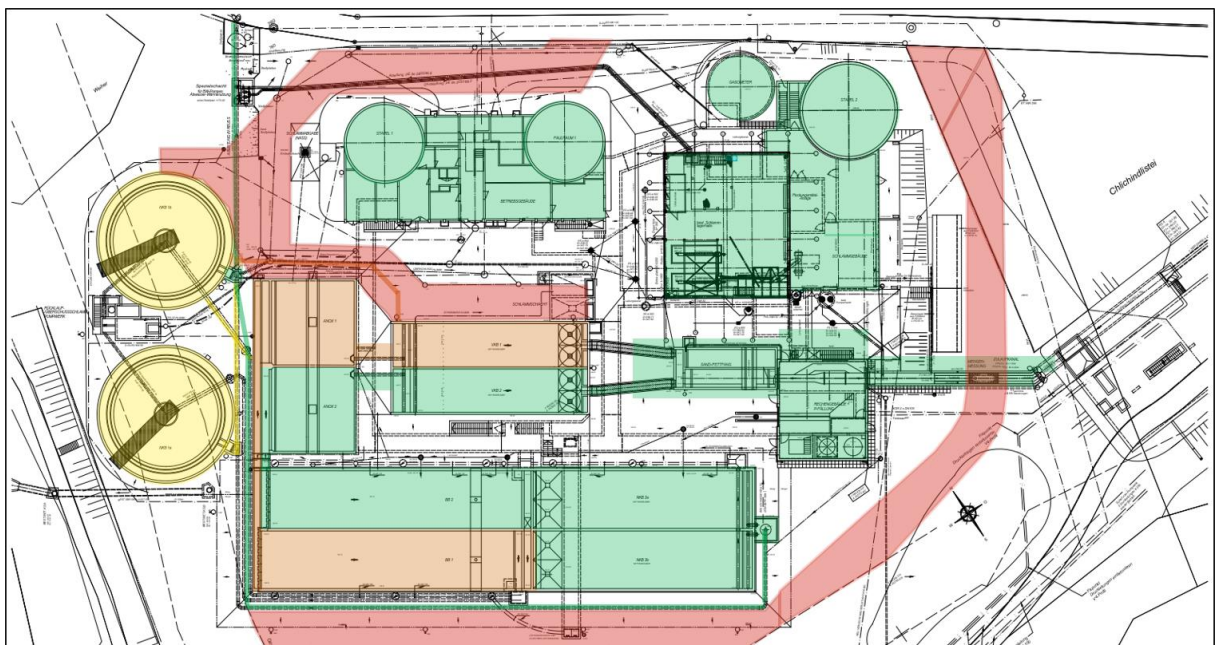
Etappe 2.3 Sanierung Strasse 1 und Rückbau Nachklärbecken 1a/1b
